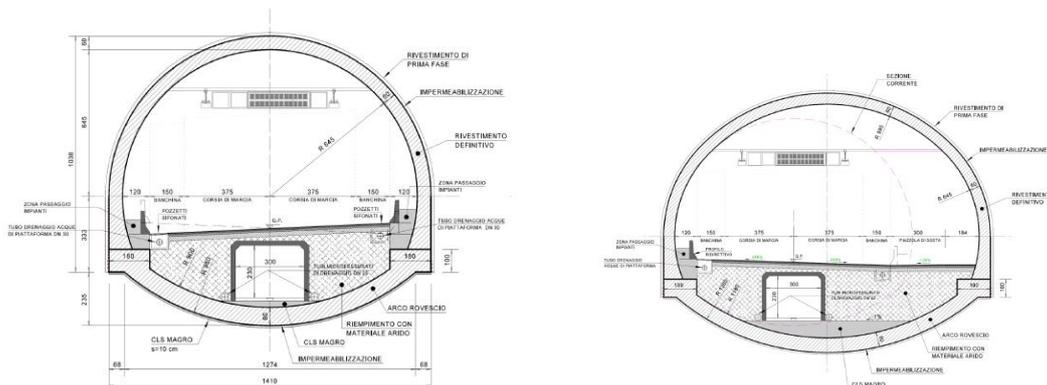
Galleria naturale – A sinistra, sezione corrente. A destra, sezione tipo con piazzola.
